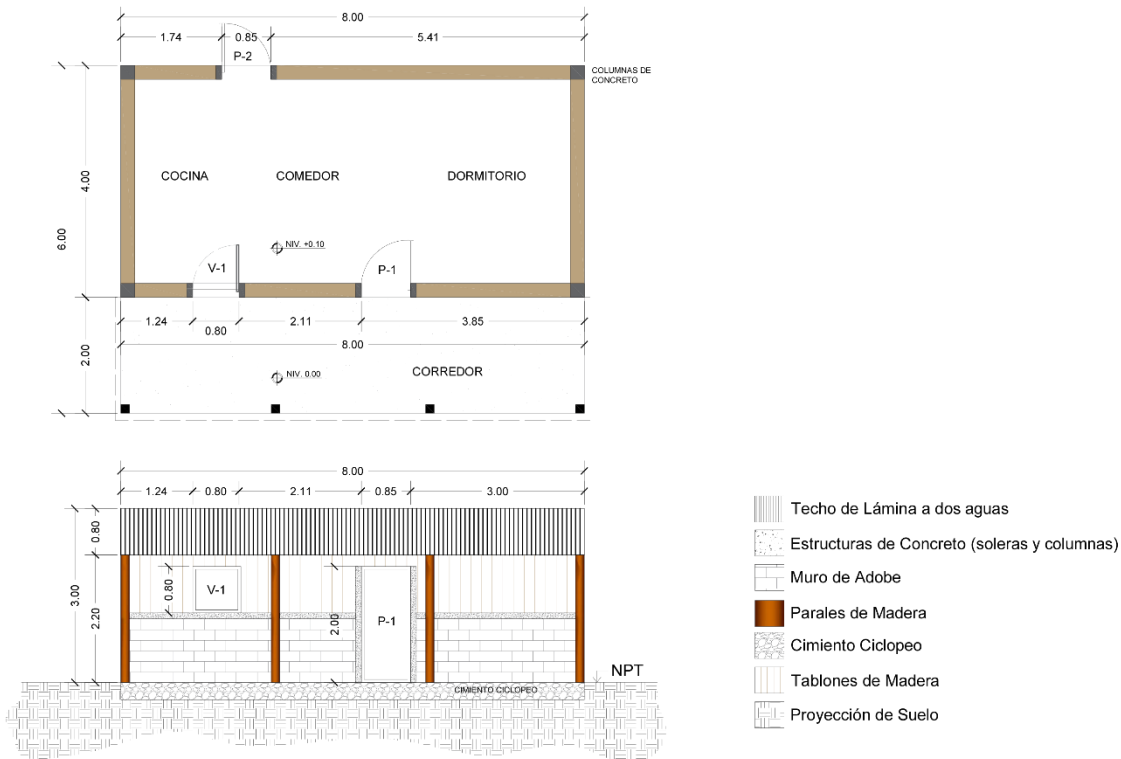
Tipo D, vivienda de adobe y estructuras de concreto
